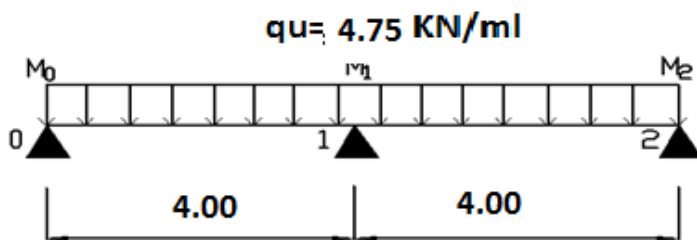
schéma statique de la poutrelle type 1 à l'ELS
